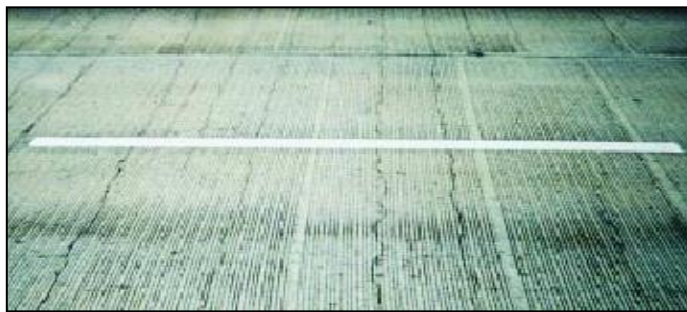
Fisuras por retracción en tablero de puente.
